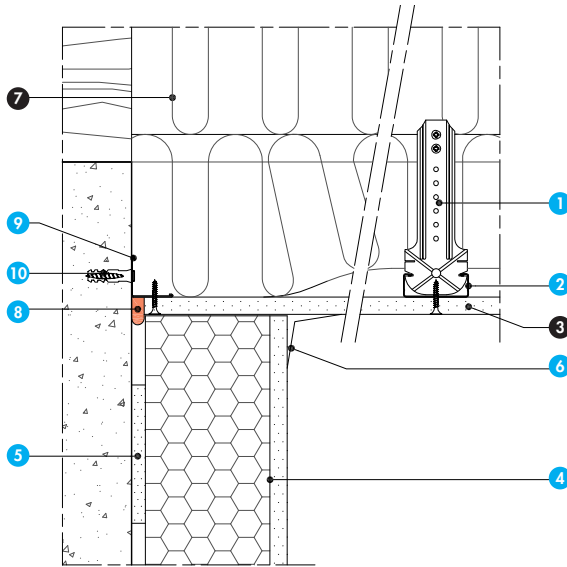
Étanchéité à l'air de la jonction plafonds/support/doublage
